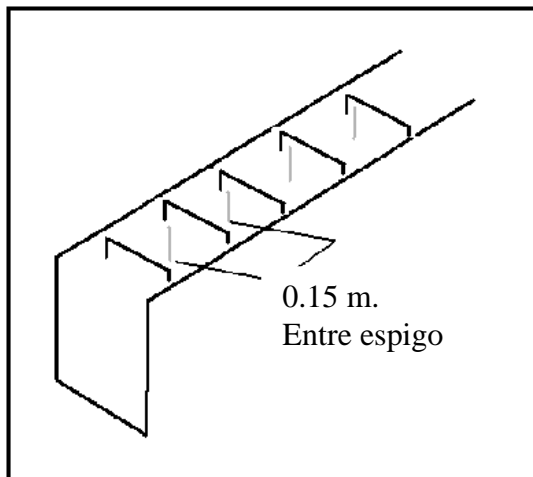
Diseño de la instalación de espigo en vigas de cimentación
